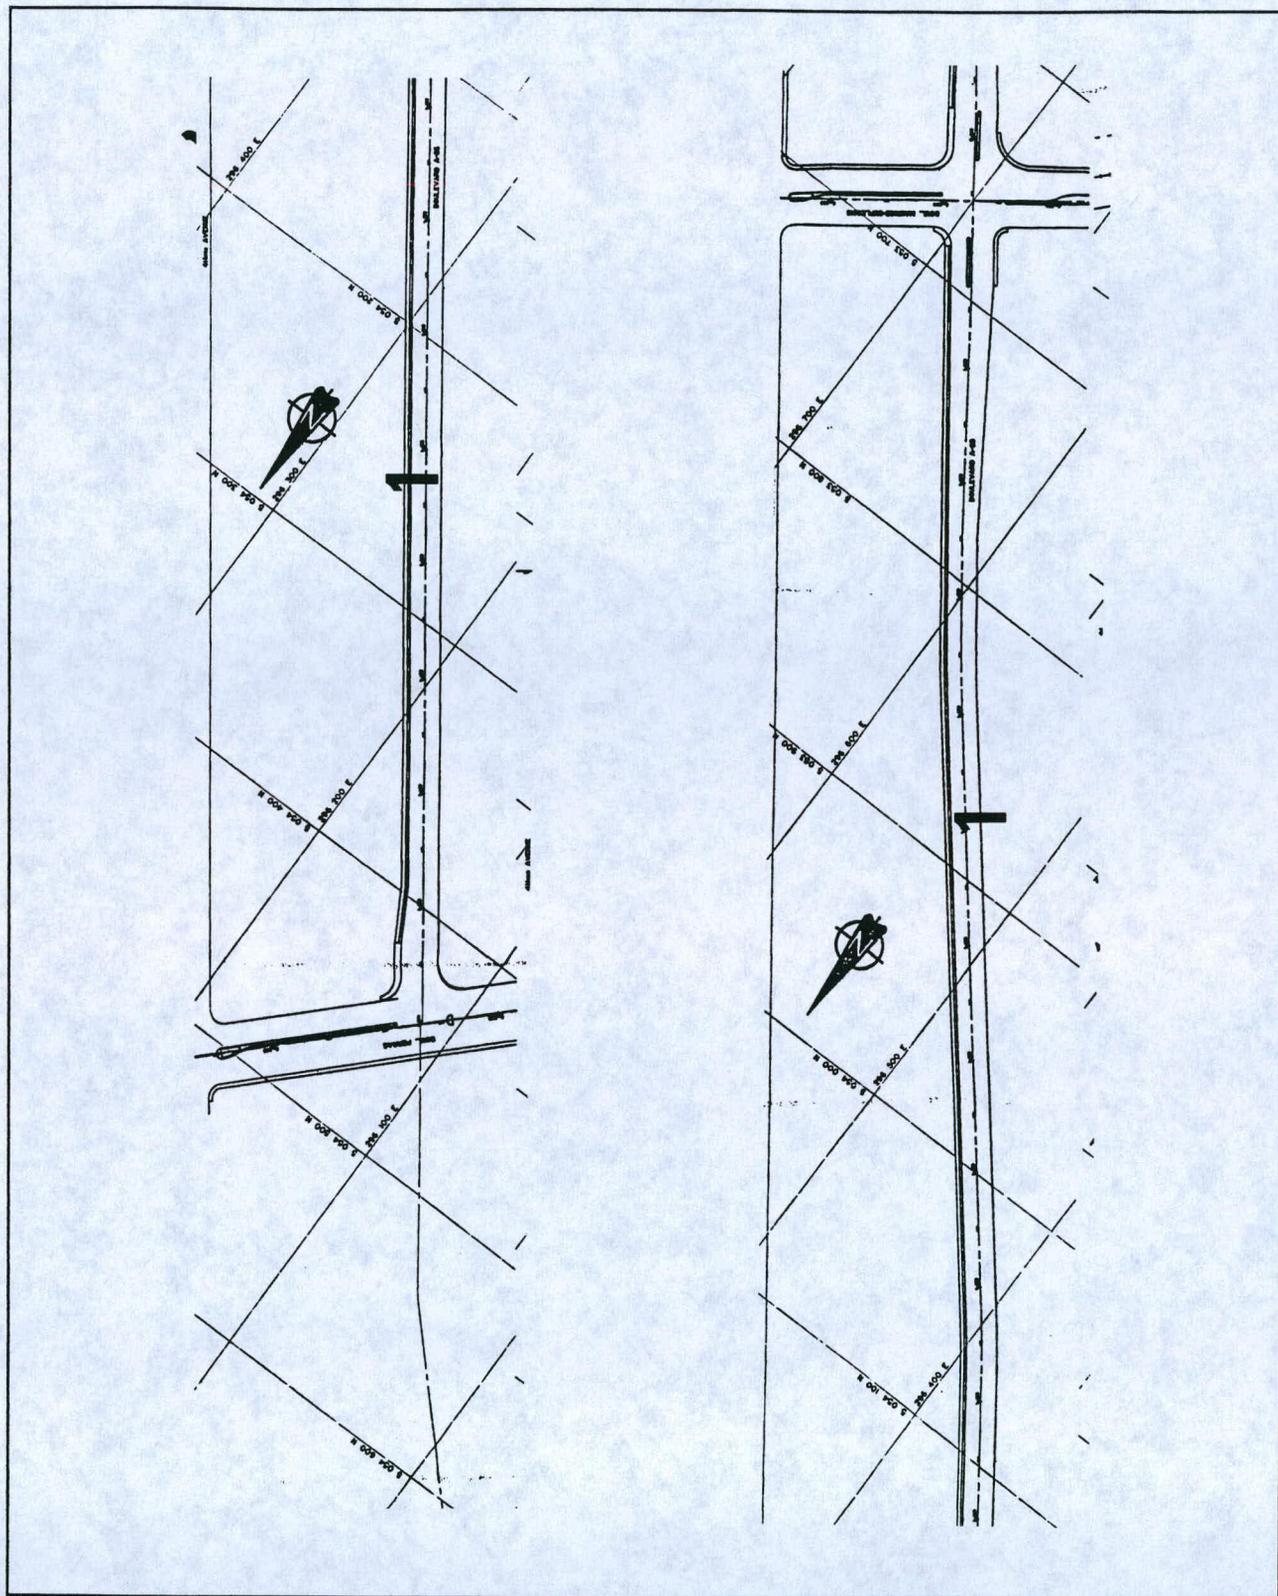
Localisation du secteur d'inventaire du projet 5200-9675, construction de la chaussée, Boulevard A-25, tronçon boulevard Perras au raccordement du boulevard Louis-Hippolyte Lafontaine, Montréal et Anjou
